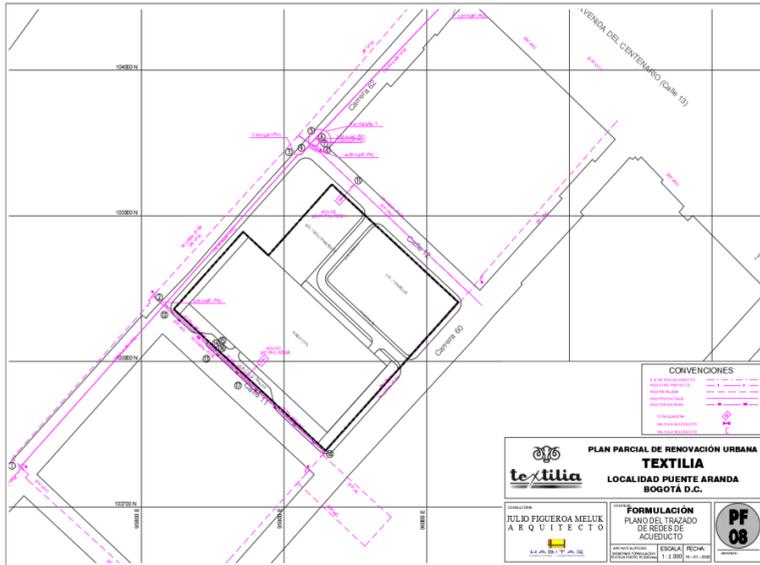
PF 08. Trazado de Redes de Acueducto
